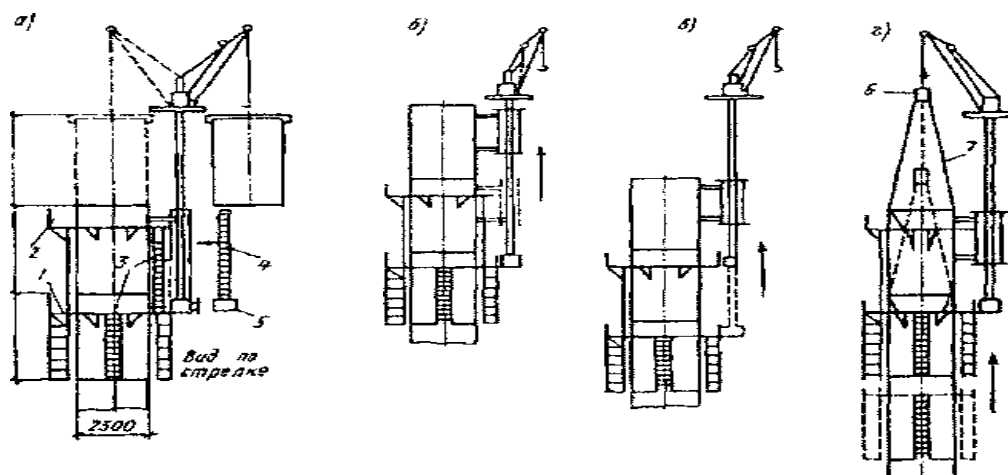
Схема монтажу трубчастої щогли повзучим краном: а - установлення секції щогли; б - перестановка обойми крана; в - перестановка стовбура крана; г - перестановка риштування; 1, 2, 5-
